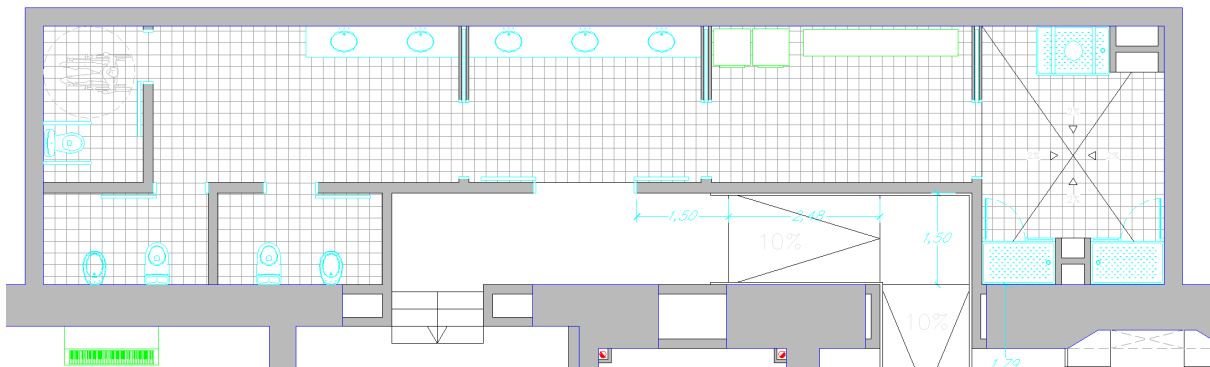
Plano planta anexa (Fuente: Propia)
